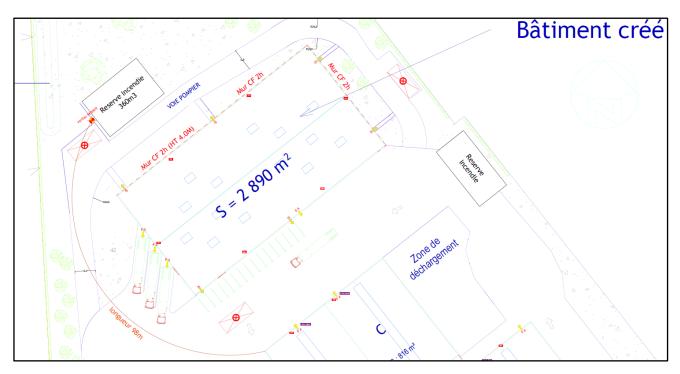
Localisation des murs coupe-feu futur bâtiment (source : sicabconstruction)
